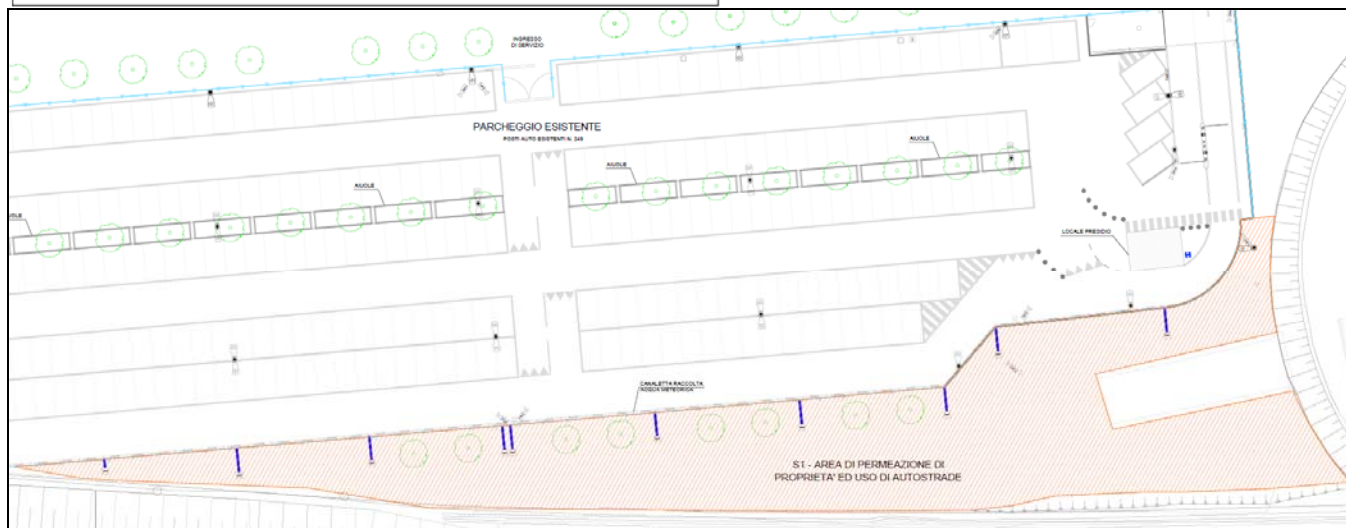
stralcio Tav. EA01: stato attuale – planimetria
